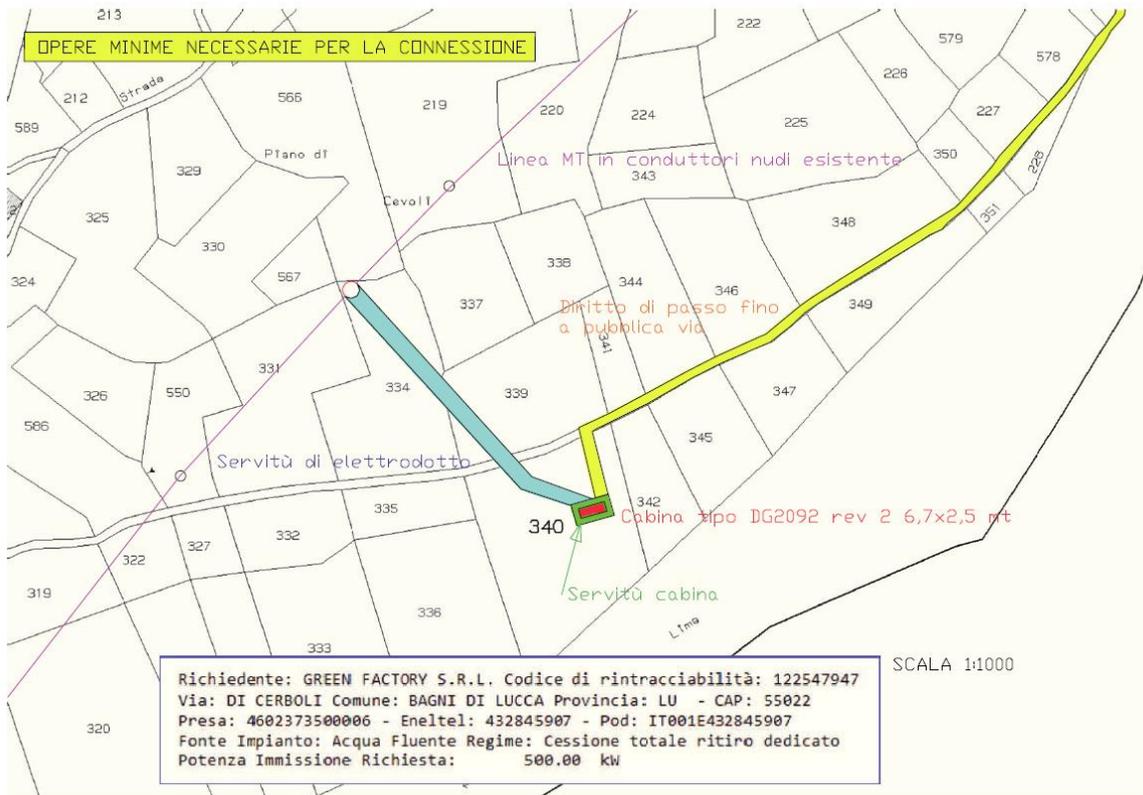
Opere minime necessarie ENEL per connessione alla rete
